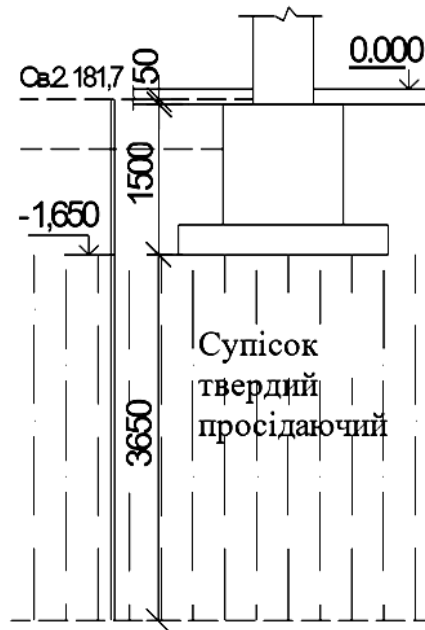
Вертикальна прив'язка фундаменту на перетині осей Г і З.
